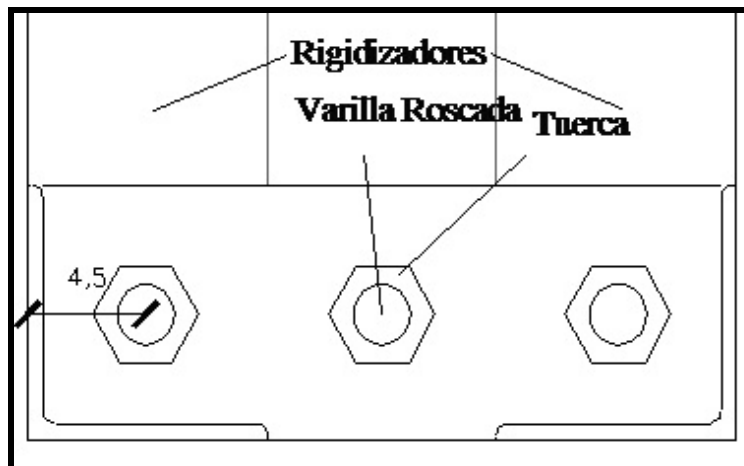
Planta de unión columna metálica - columna de H°A°.
